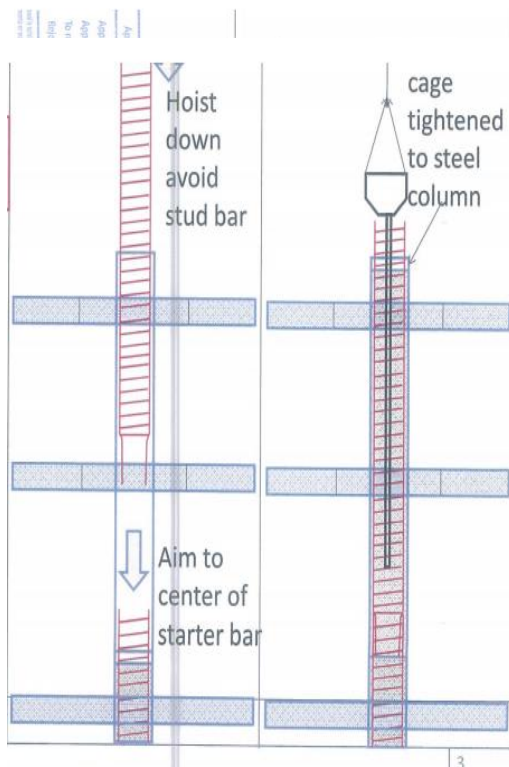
Layout Postmark Concrete Filled Steel Tube (CFT).
